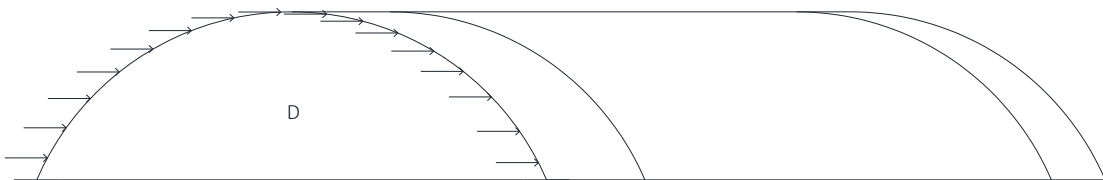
Esquema de carga de viento frontal sobre arco externo frontal
